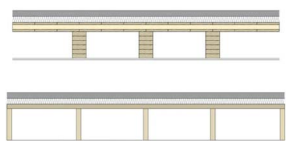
Soluciones de forjado mixto nervado con CLT o LVL. Sylva Kit, Stora Enso.
